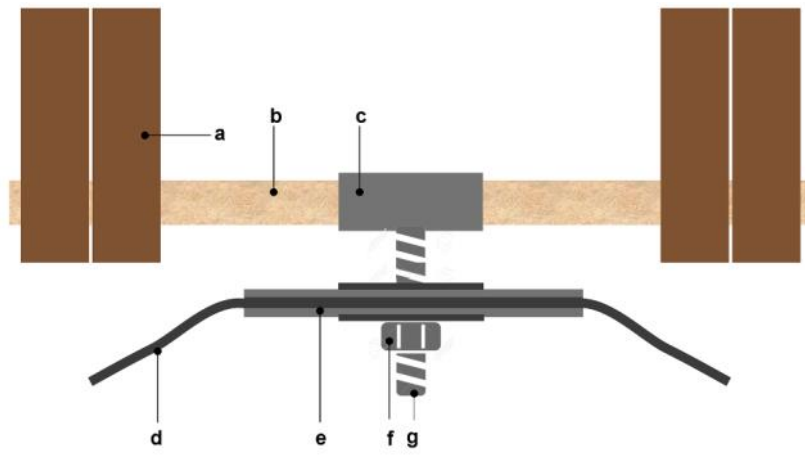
Izquierda: Plano detalle sujeción cubierta interior con abrazadera y perno
